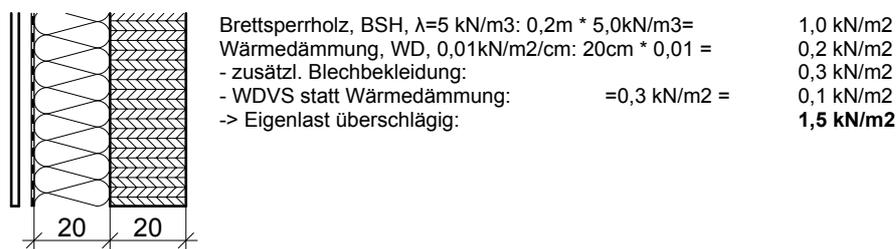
Tragende Außenwandkonstruktion aus Brettspertholz
